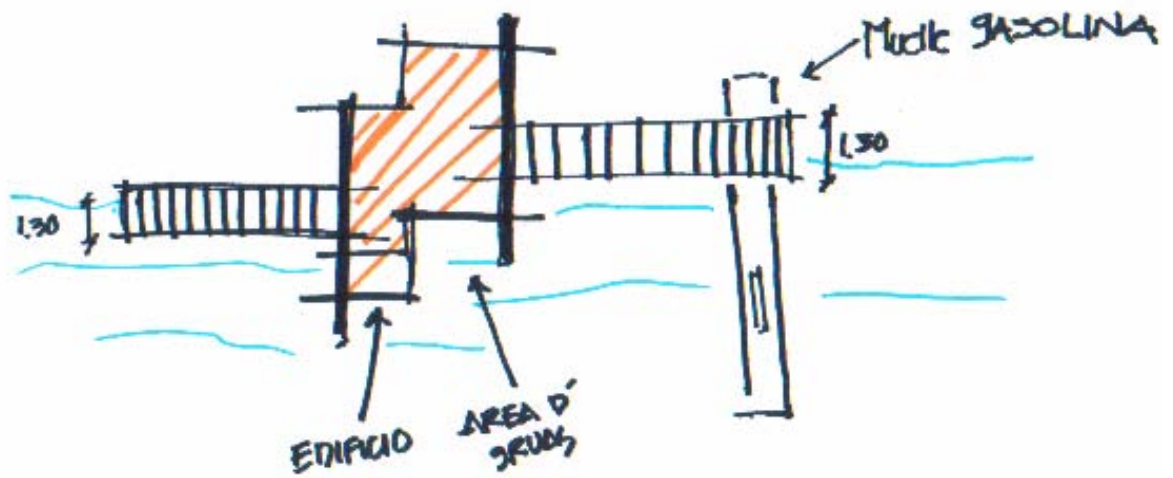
croquis de la planta del tercer modelo experimental.
